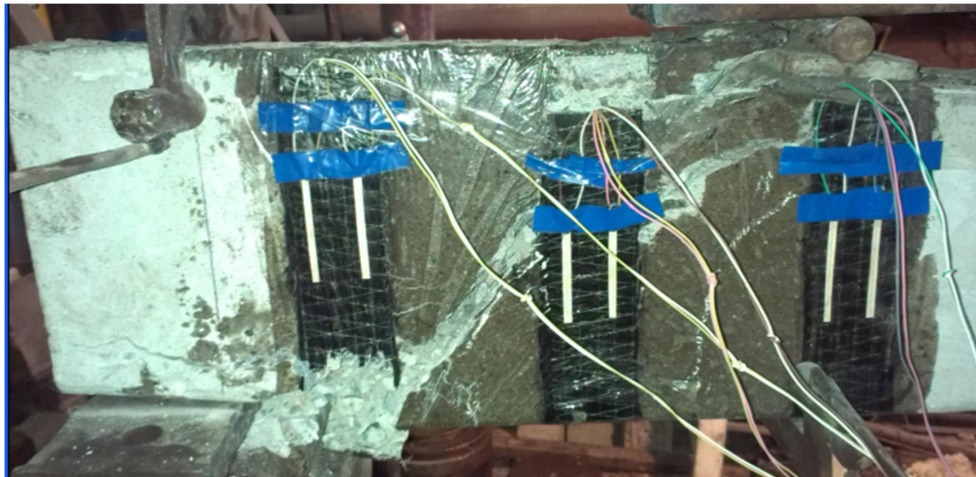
Разрушение по поперечной силе опорной зоны балки, усиленной вертикальными полосами из фиброармированной сетки
